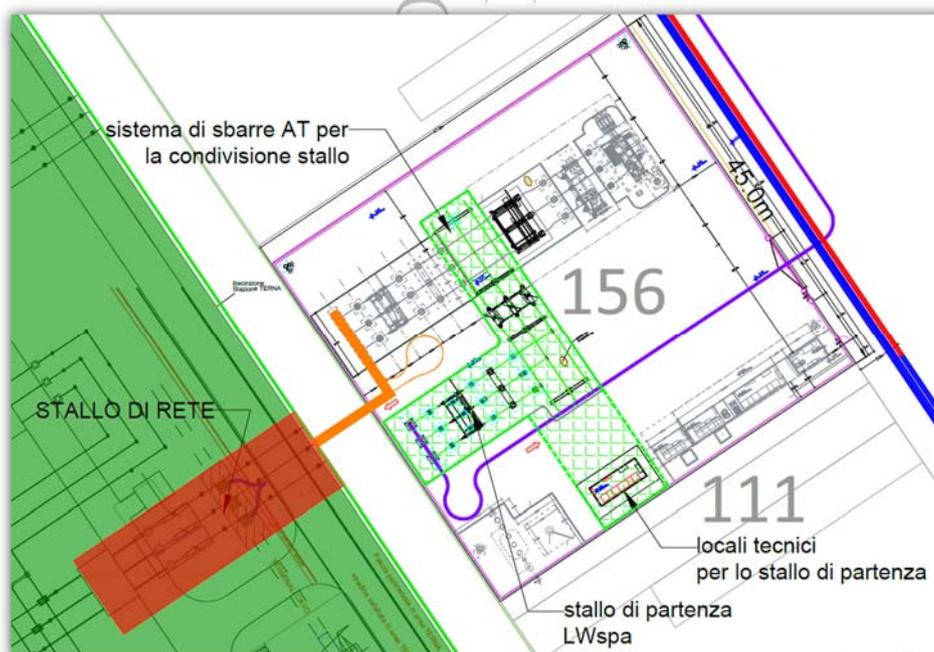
Stralcio planimetrico con evidenza delle nuove apparecchiature da realizzare nella SSE Lucky Wind 4 per la condivisione
